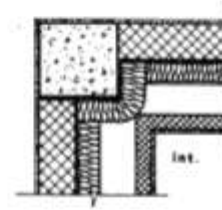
A-2: Pilastro d'angolo: correzione del ponte termico.
